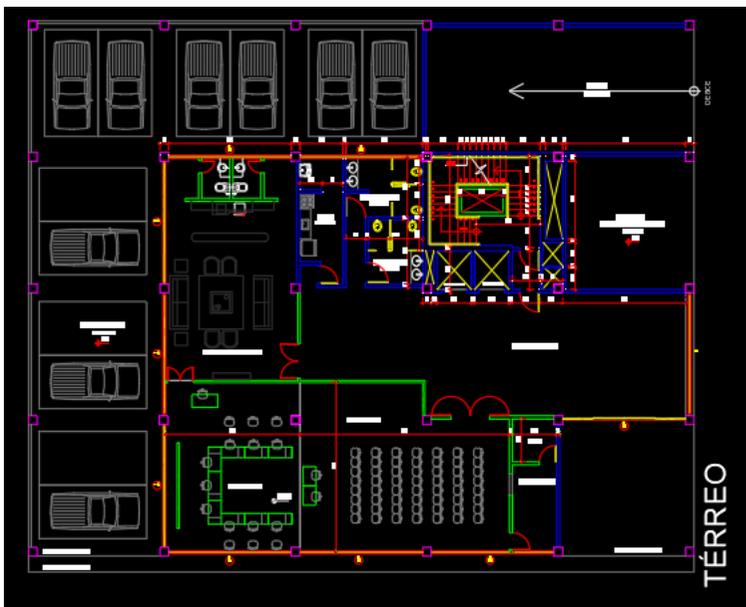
Planta do Pavto Térreo do Ed. Ruy Barbosa
